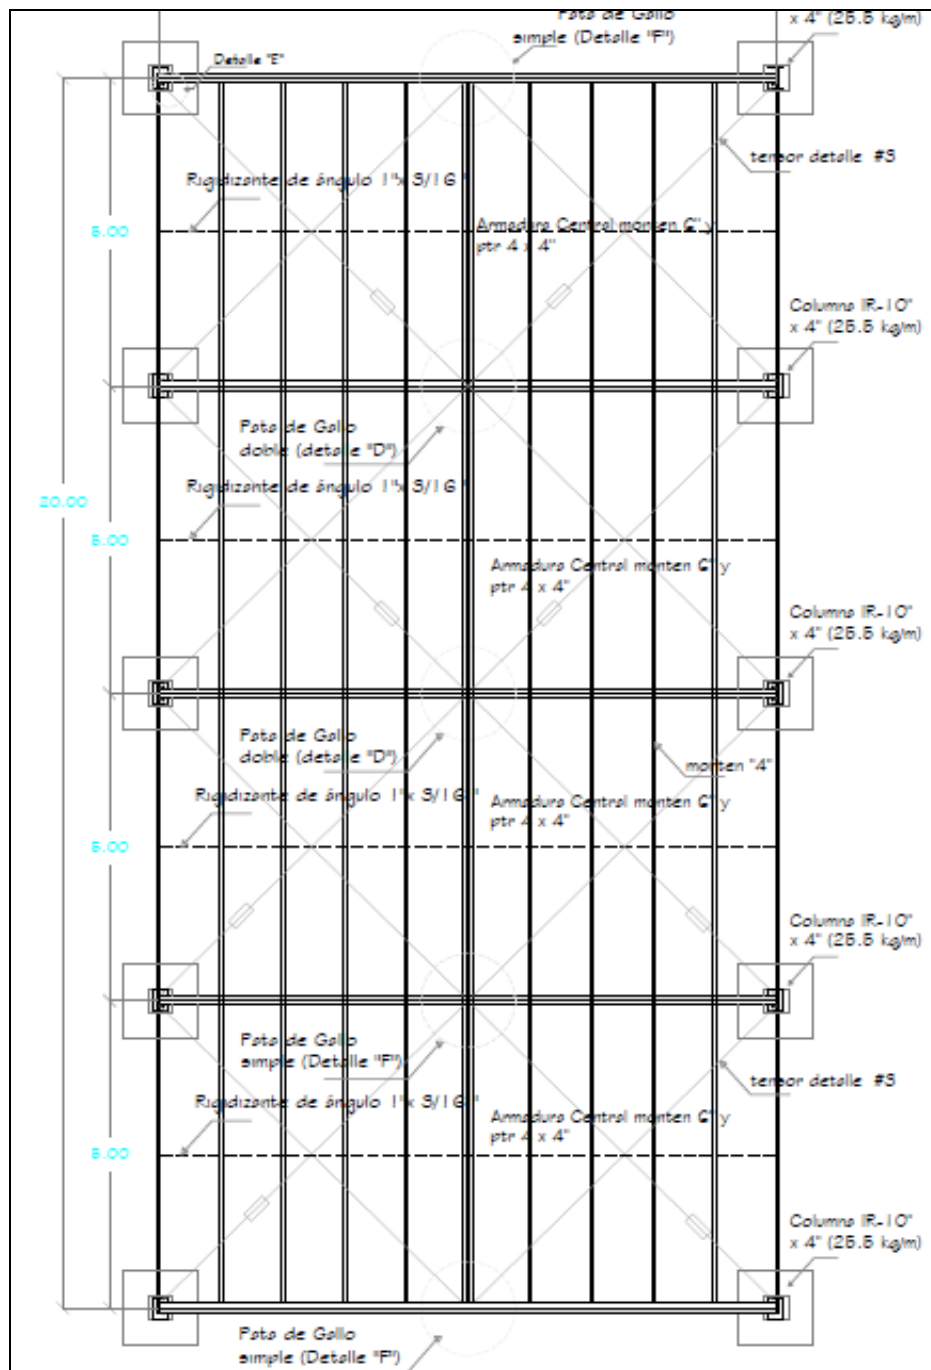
Dimensiones de la fachada de techumbre. Ver detalles en Plano 4.
